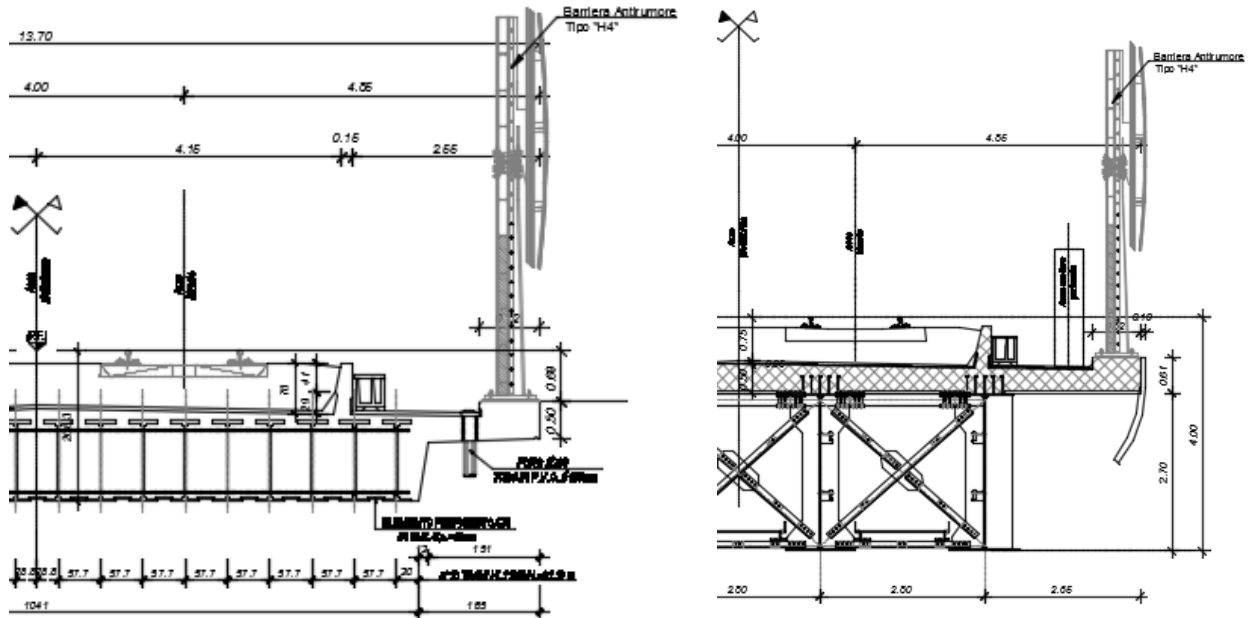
Stralcio sezione tipo su opera d'arte: viadotto a travi incorporate e a struttura mista acciaio – cls
